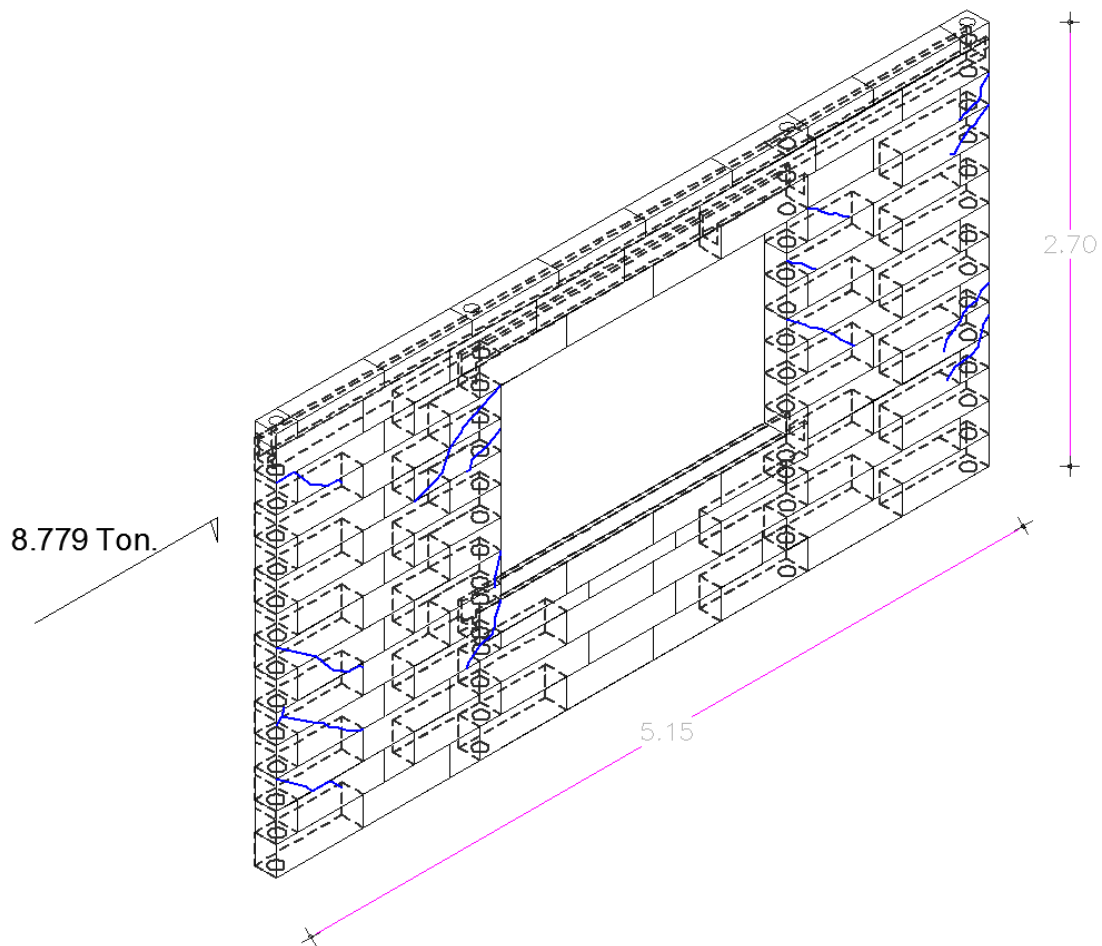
Carga Lateral y posible Estado de Daño del muro "O" Mampostería Confinada Interiormente empleando Block de concreto celular
